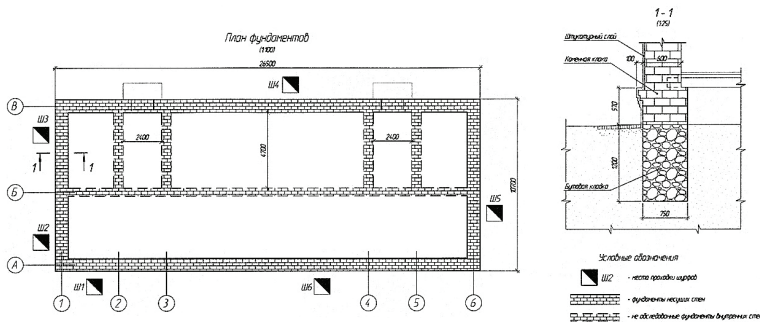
Схема расположения шурфов у стен дома. Поперечное сечение фундамента (составлена подрядчиком)
